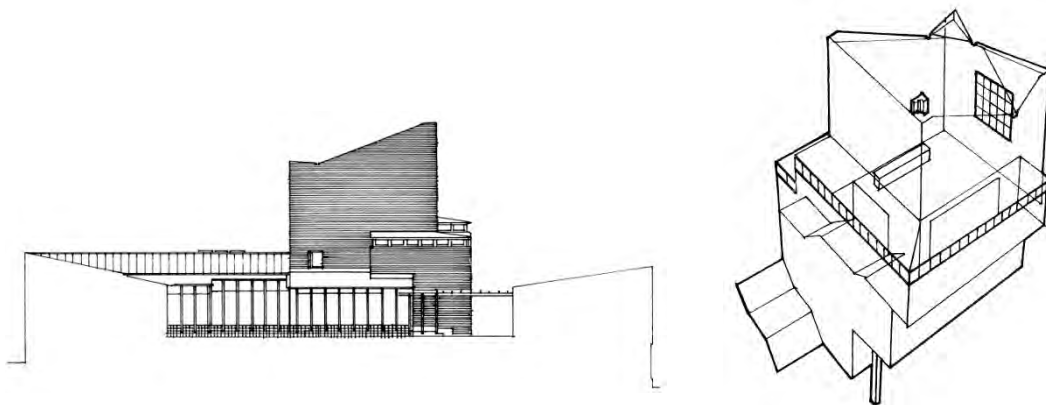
Corte do conjunto e fachada com janelas paralelas à circulação e as aberturas escalonadas no prédio da Câmara. Saynatsalo, Finlândia.
